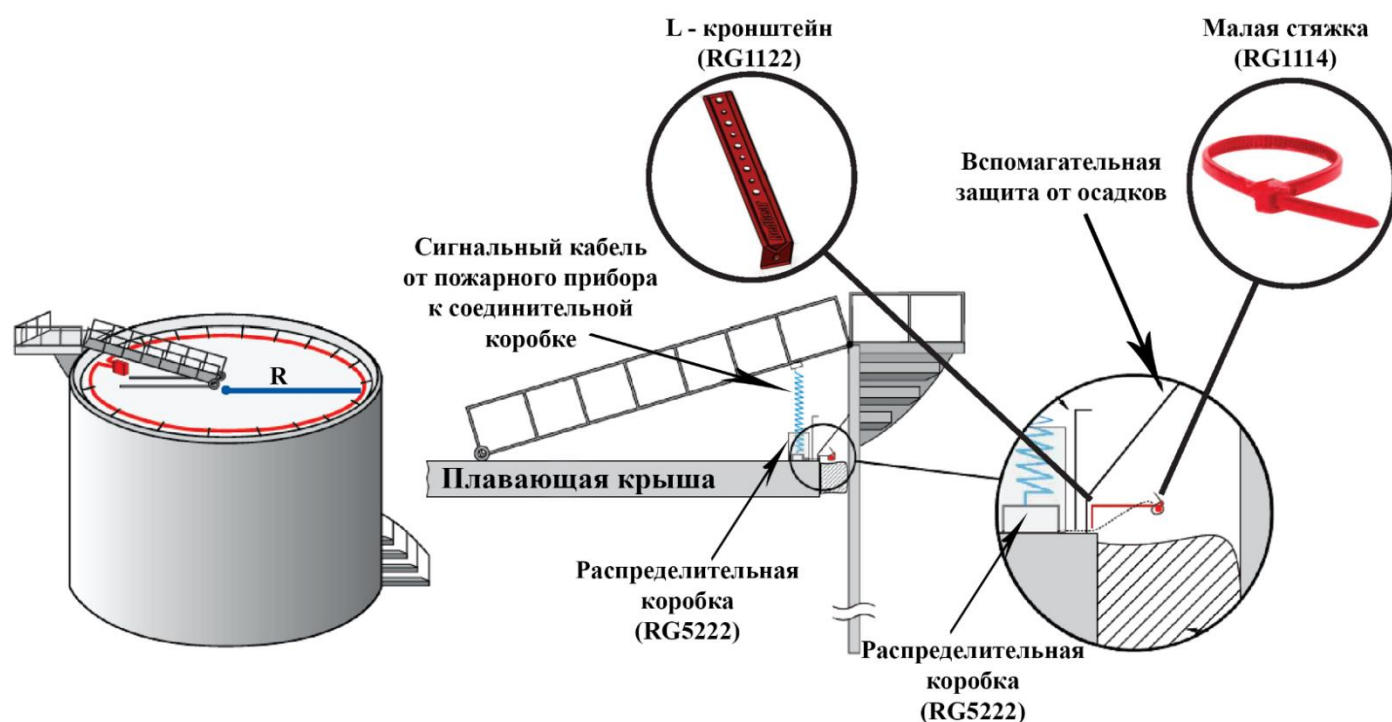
Защита резервуаров с плавающей крышей
